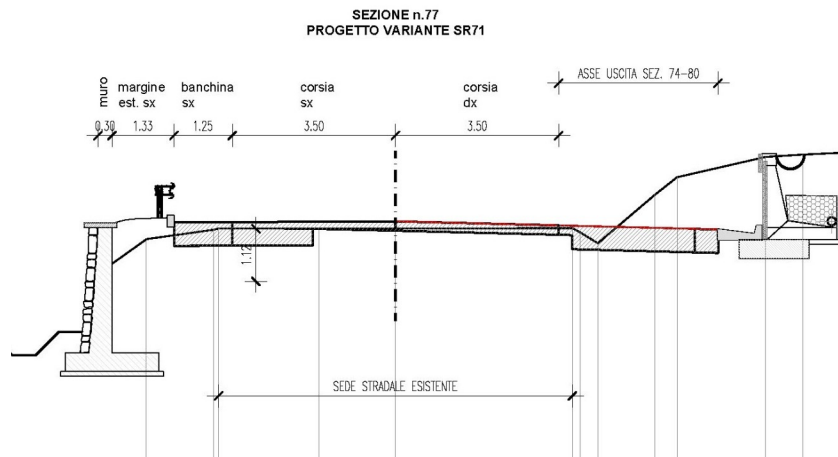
Progetto variante SRT 71: sezione n. 77
